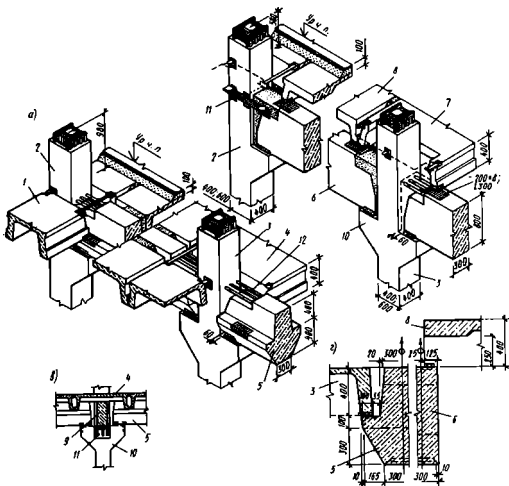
Многоэтажное производственное здание с блочным каркасом из сборных железобетонных конструкций:
